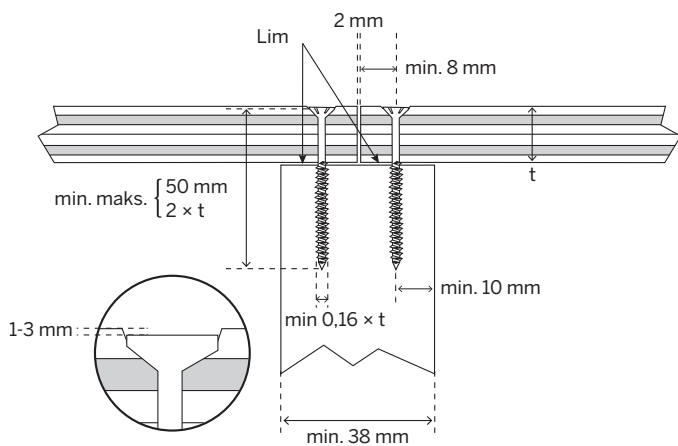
Metsä Wood krydsfiner (TG2) plademontage på gulvbjælker
